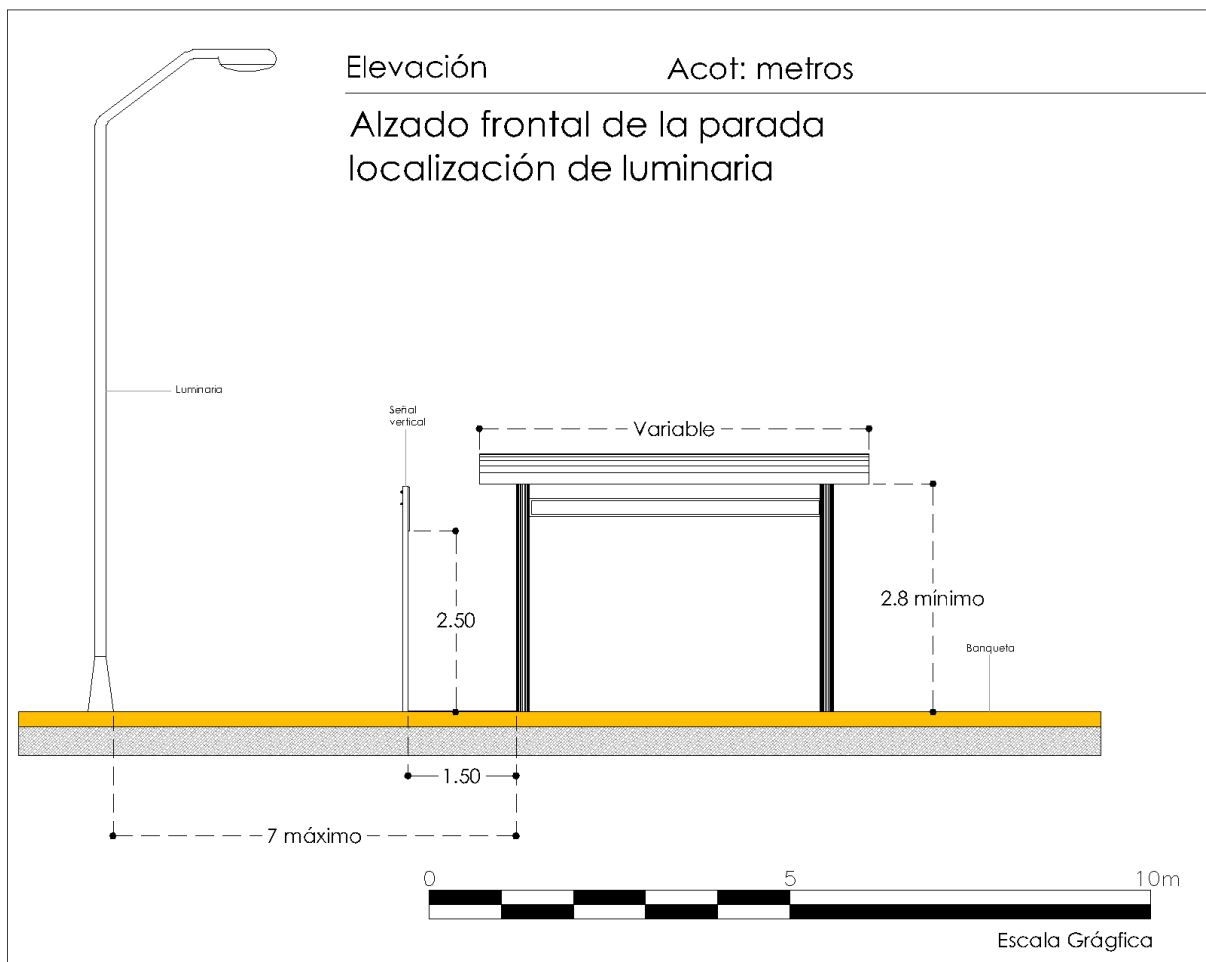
Localización de luminaria (Elaboración propia IMEPLAN, 2020)
